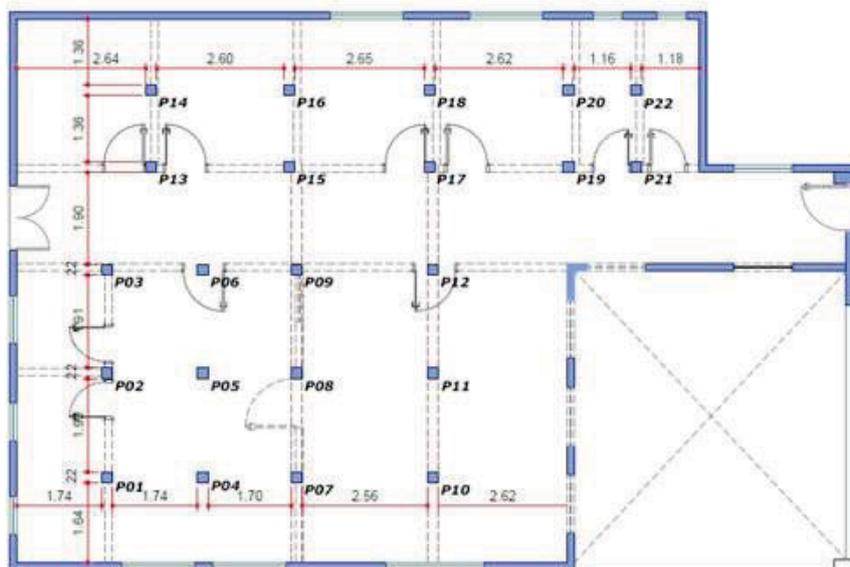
Representação da locação dos pilares do pavimento inferior e projeção do pavimento térreo.
